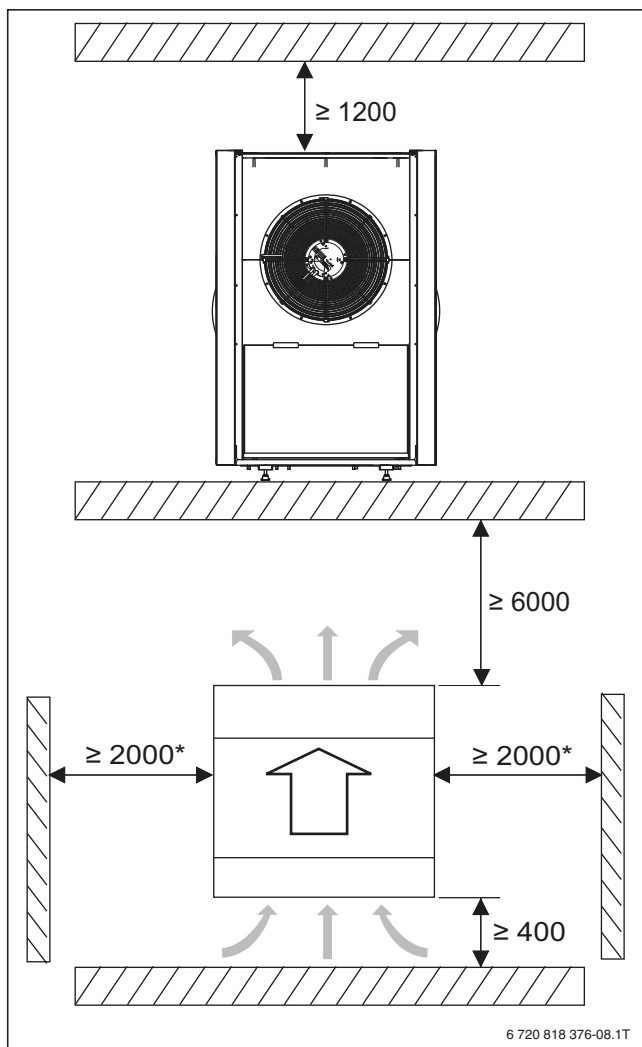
Mindestabstände WLW196i..AR (Maße in mm)
